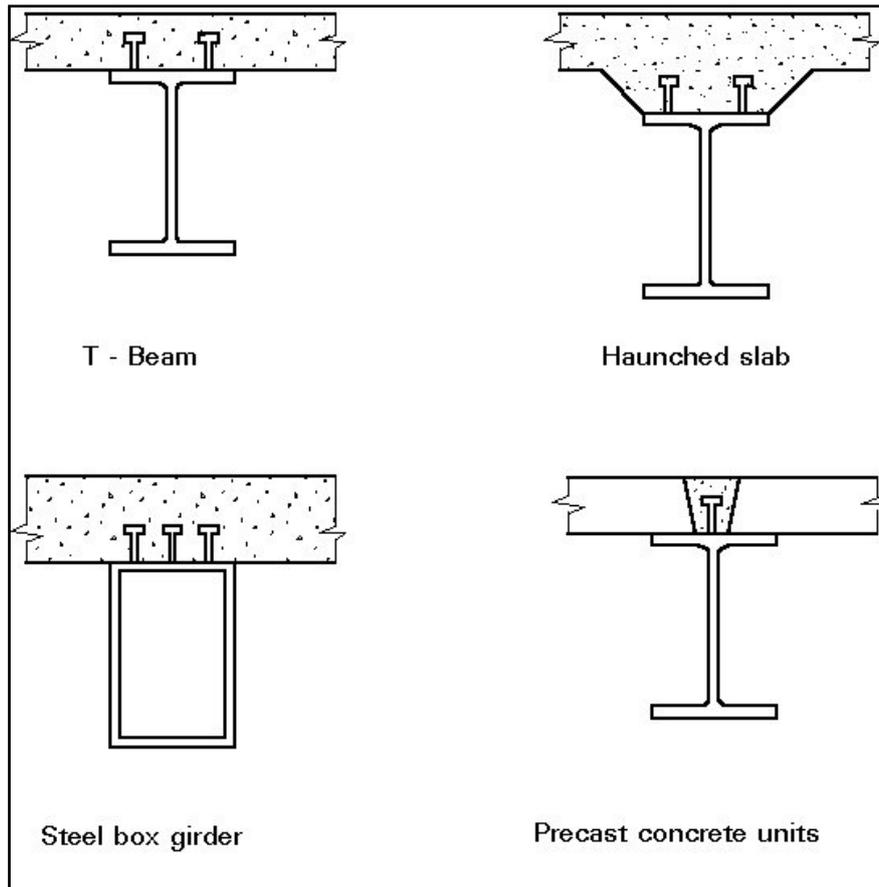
différentes sections de poutres mixtes coulées in situ.
